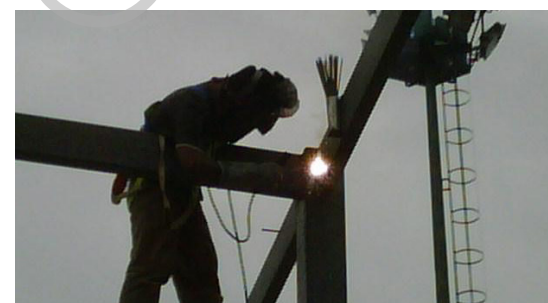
Soldadura de viga IPN a columna metálica
